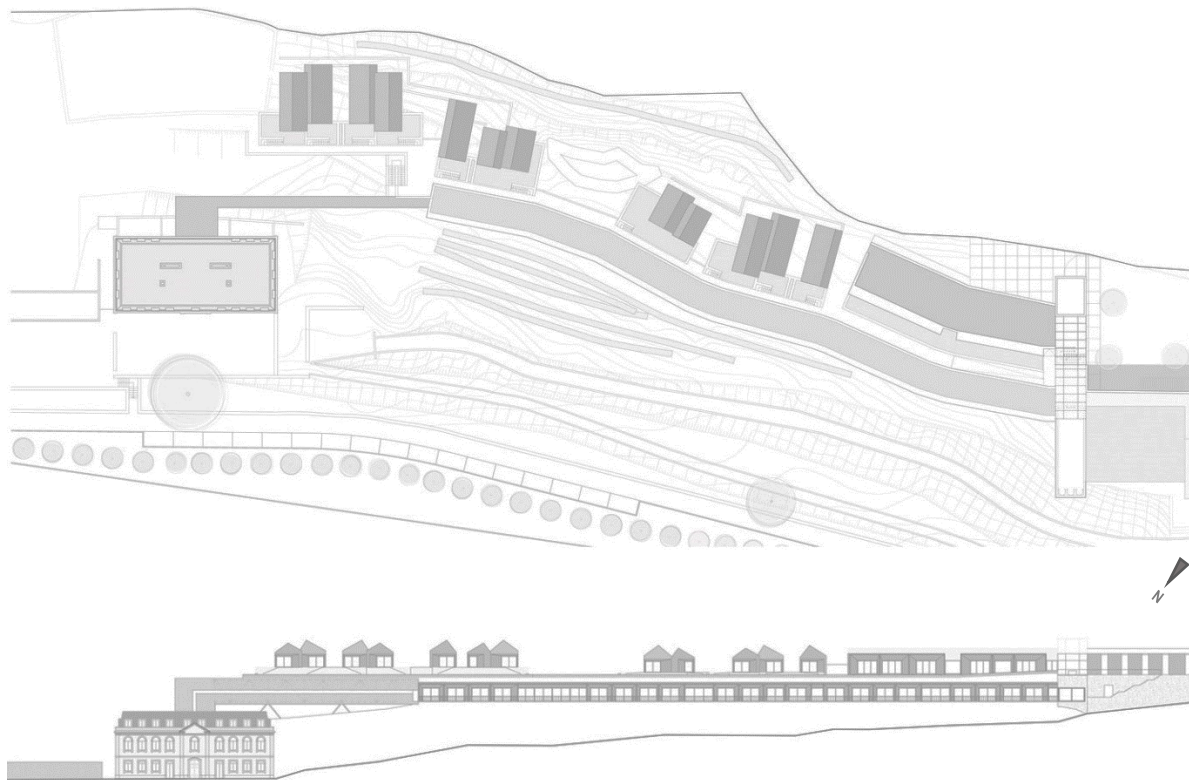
Planta de implantação e alçado frontal | Fonte: Archdaily
